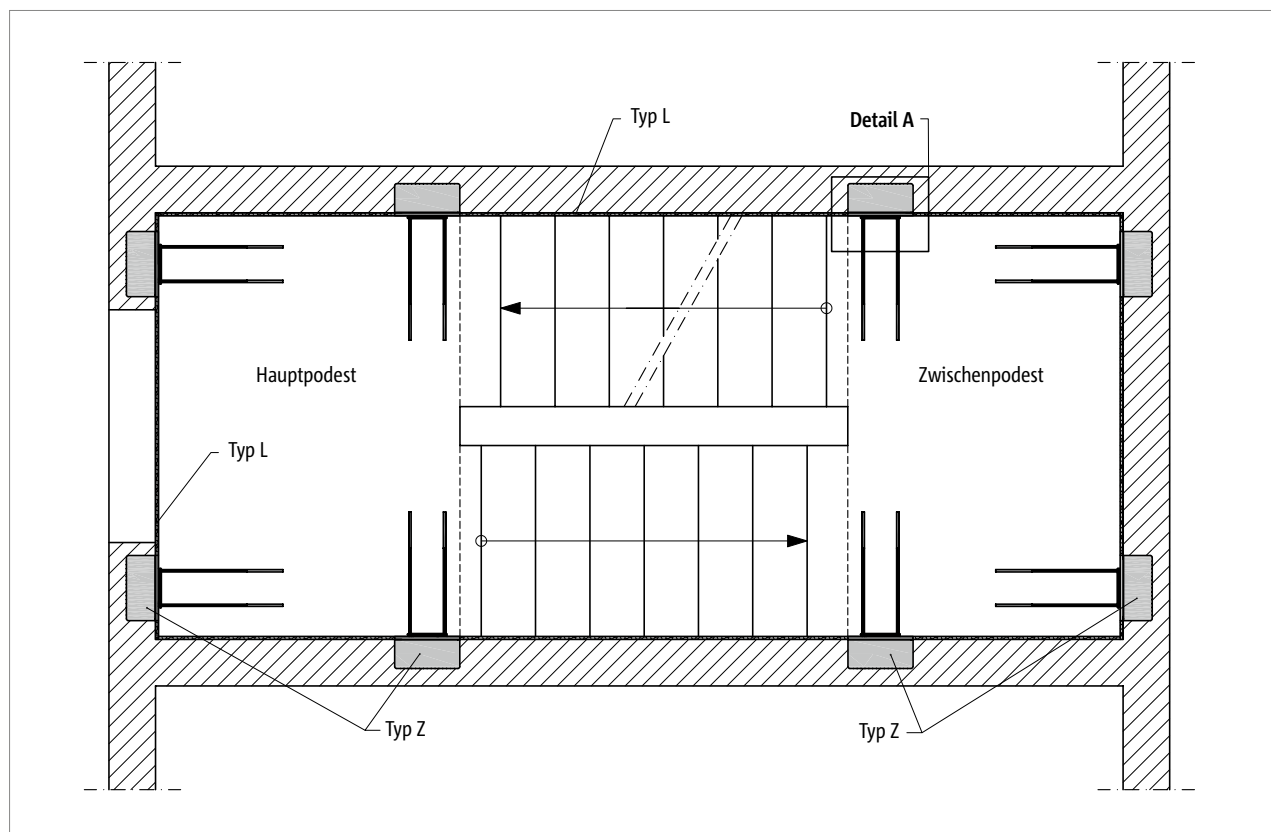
Tronsole® Z: Alternative Elementanordnung im Grundriss
